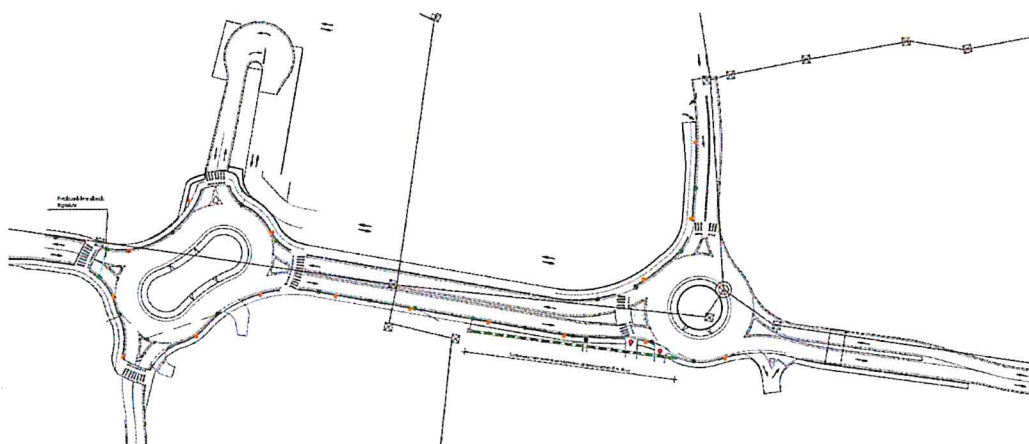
Planimetria di progetto con indicazione della rete fognaria esistente e tombamento del fosso
